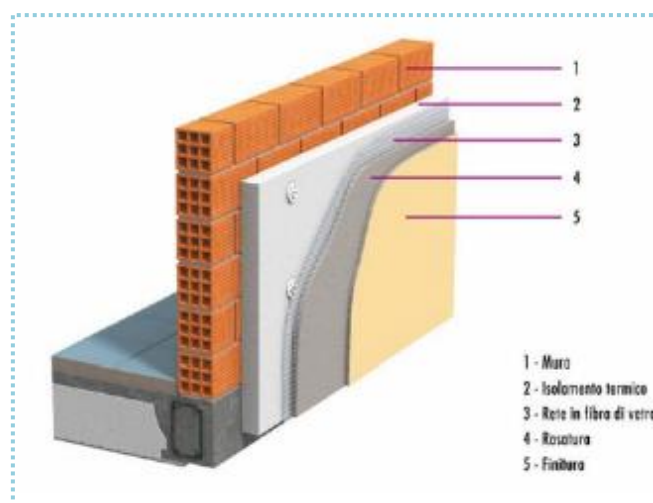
Schema tipo di posa di un isolamento a cappotto
